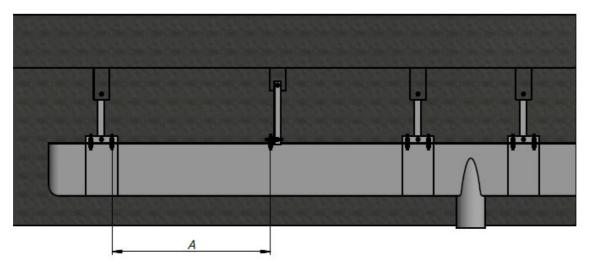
Монтаж водоотводных лотков на бетонные, железобетонные, каменные, армокаменные конструкции
